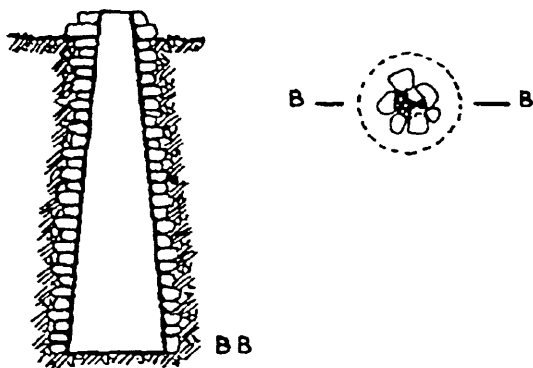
Sardara. Santa Anastasia: planimetria e sezione del pozzo situato all'interno della chiesa (da ZERVOS 1954).
